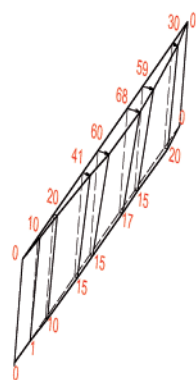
Схема поздовжнього розколу стіни в рівні 1-го поверху
